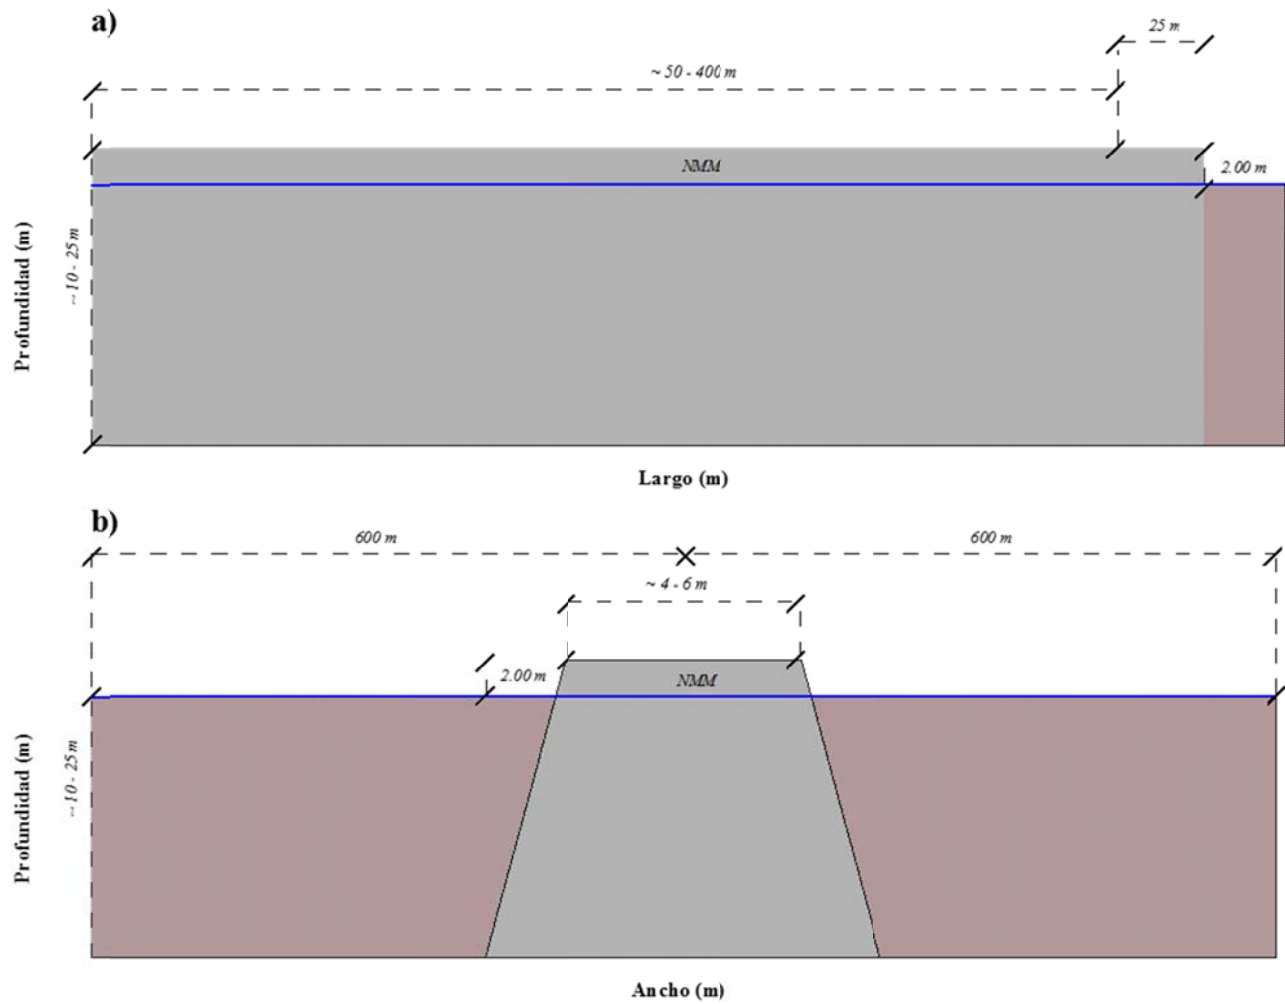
Corte transversal de la alternativa de actuación 6: a) sección A – A, b) sección B – B.
